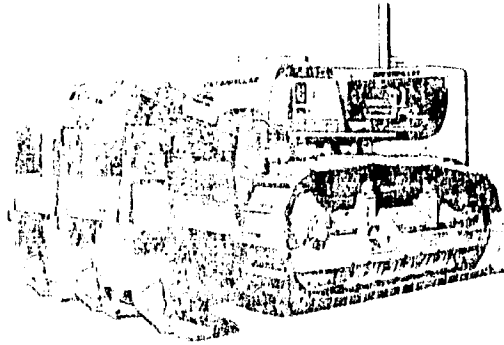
C EQUIPO DE DESGARRAMIENTO INSTALADO EN TRACTOR.
